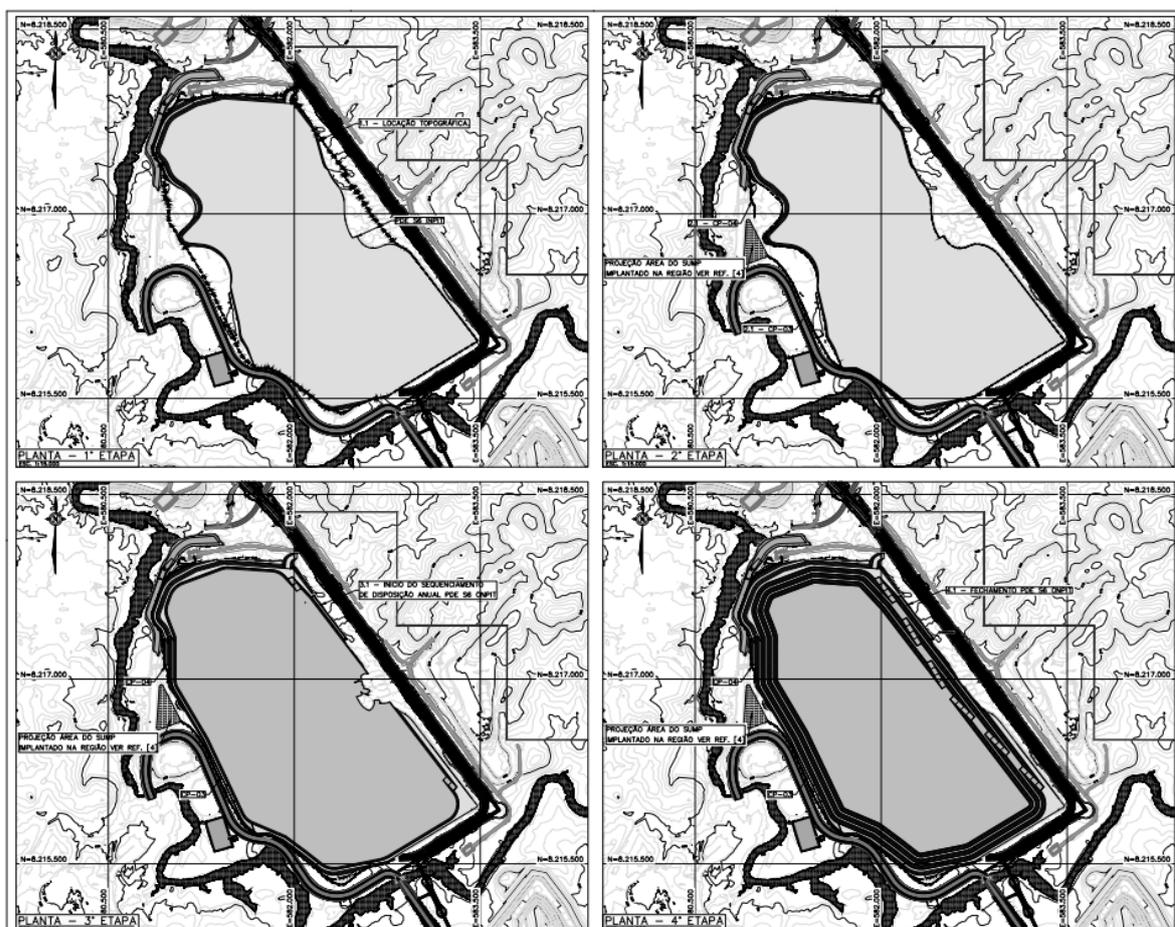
Faseamento construtivo da Pilha de Estéril S6
